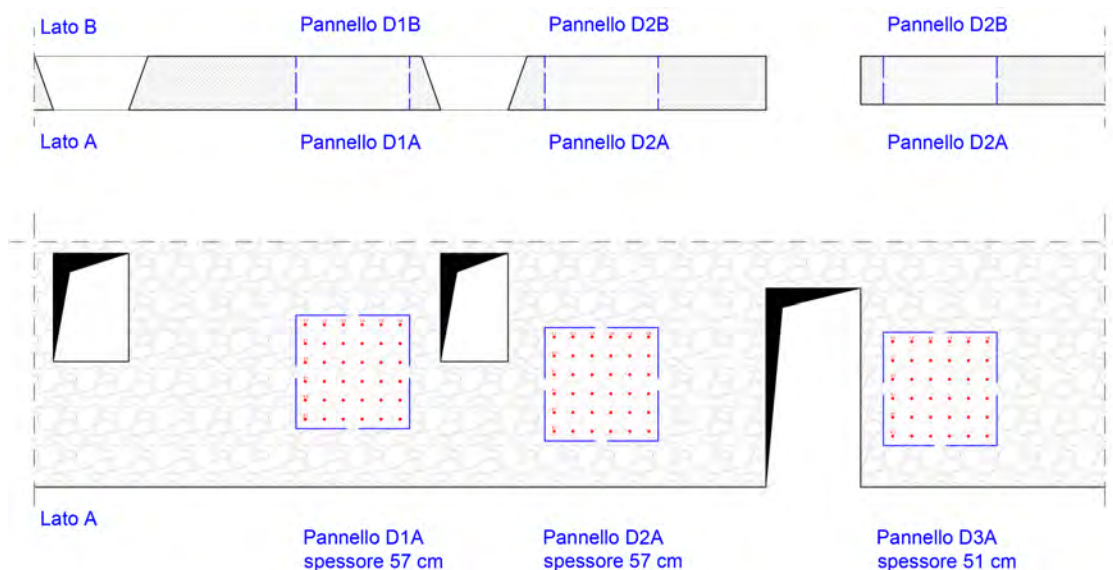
Schema trasparenze soniche pannelli D1, D2, D3 in pianta e in prospetto
